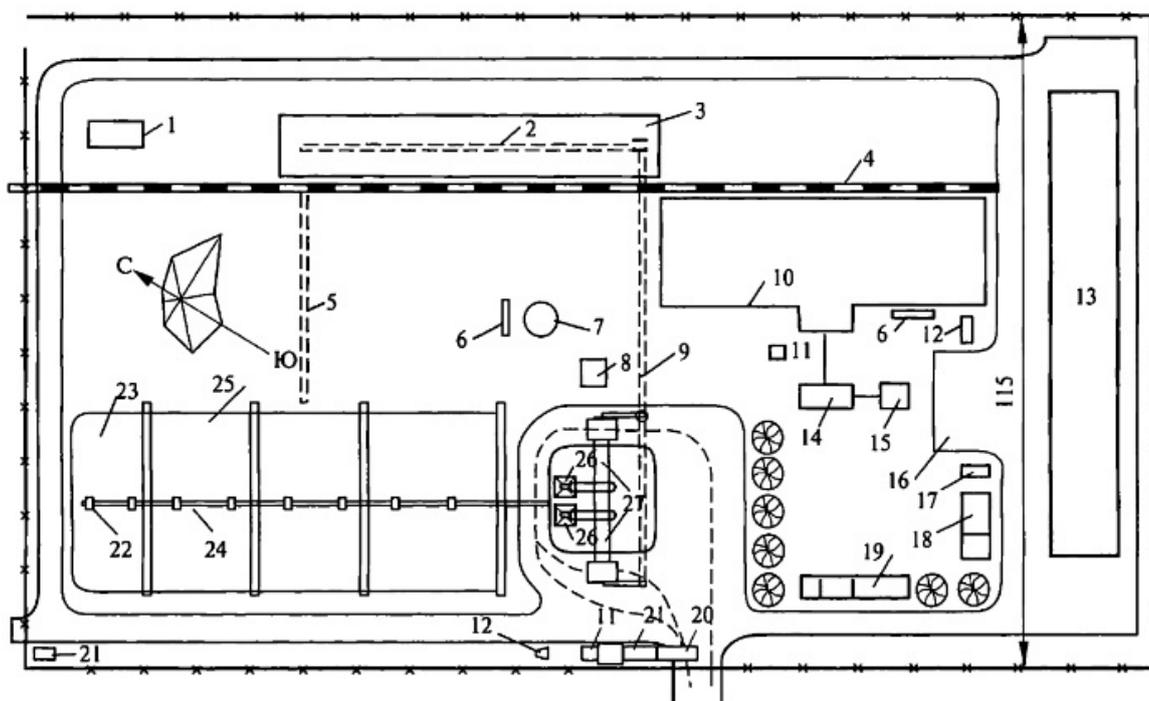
Генеральный план асфальтобетонного завода с двумя смесителями:
